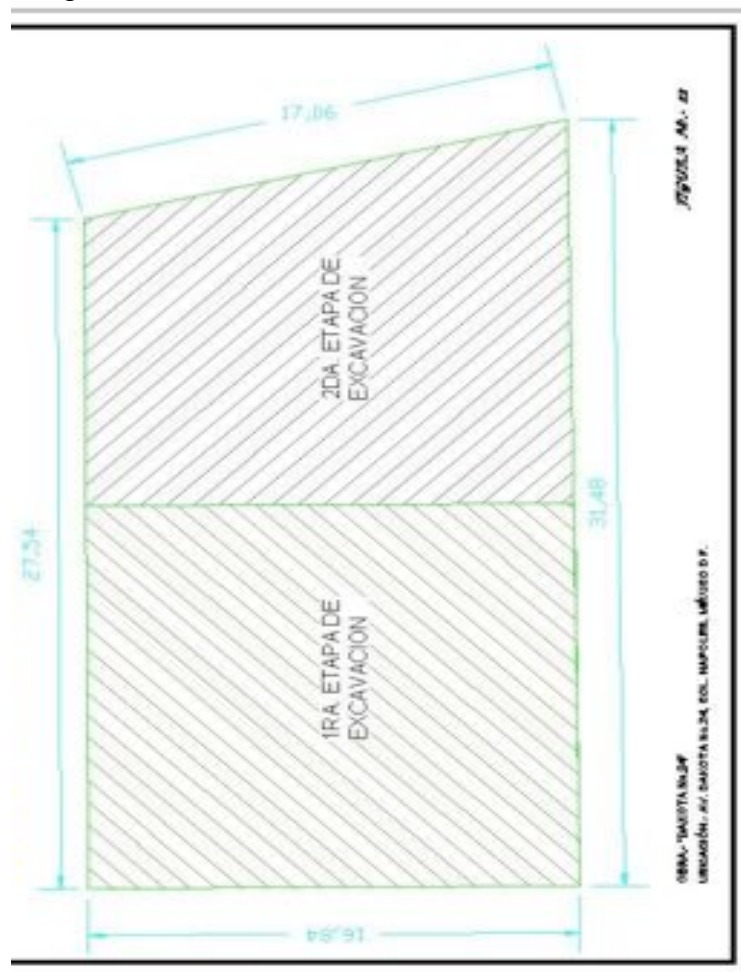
ETAPAS DE EXCAVACIÓN.
